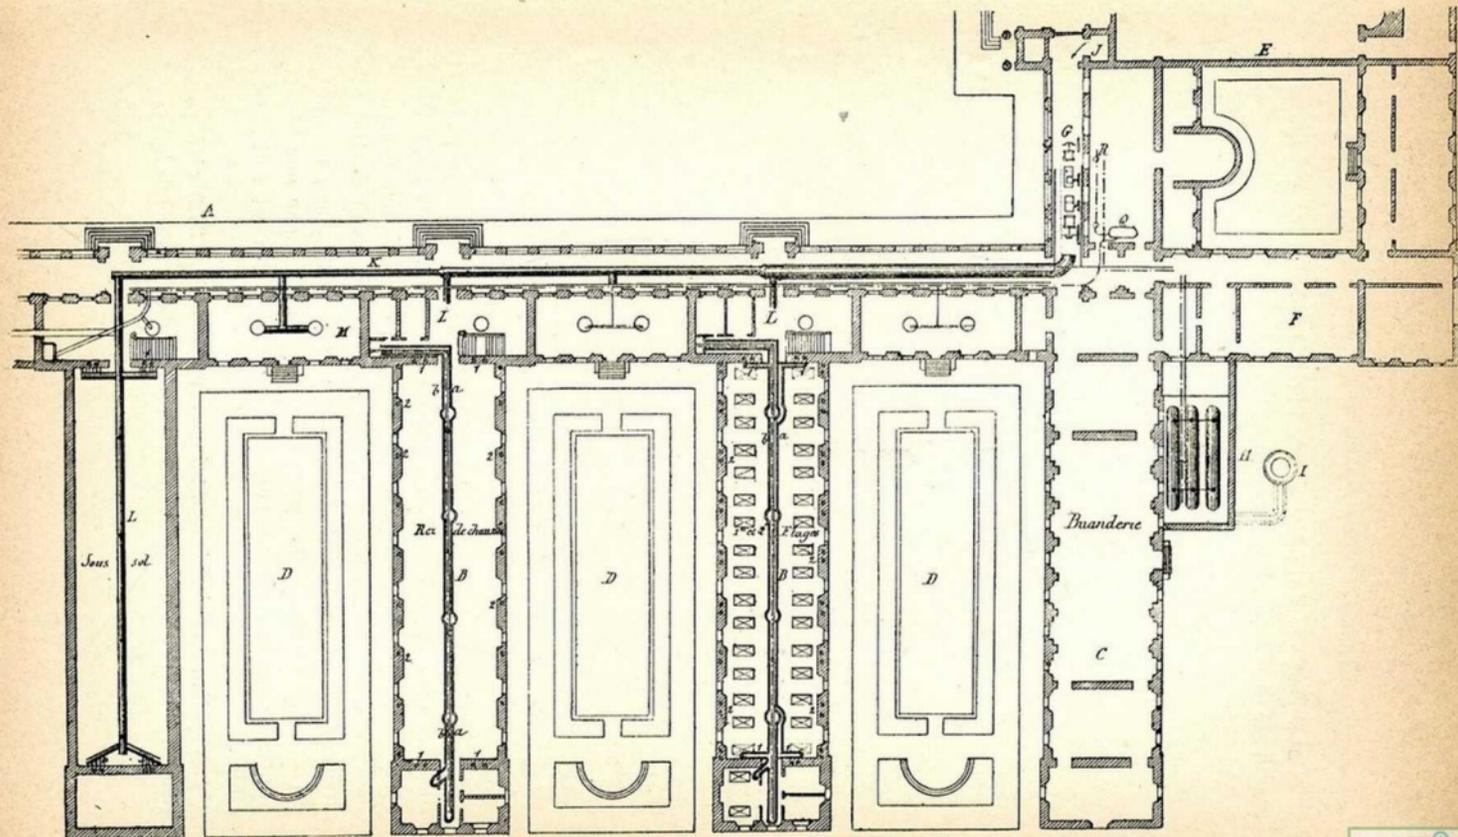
Chauffage de l'Hôpital Lariboisière. Plan.
